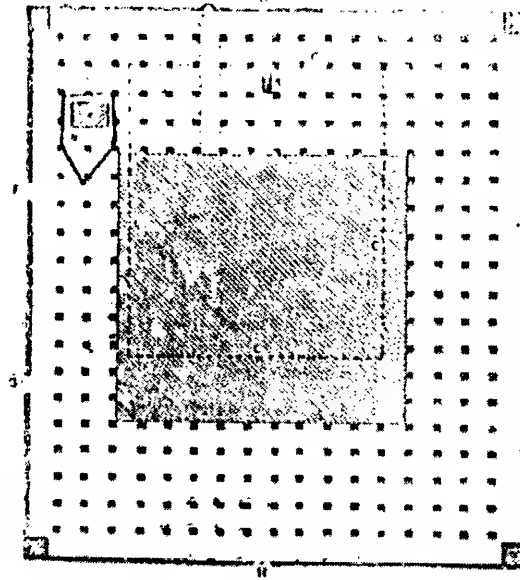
المسقط الأفقي لمسجد الكوفة الأول (١٥٠هـ/٦٣٦م) .
